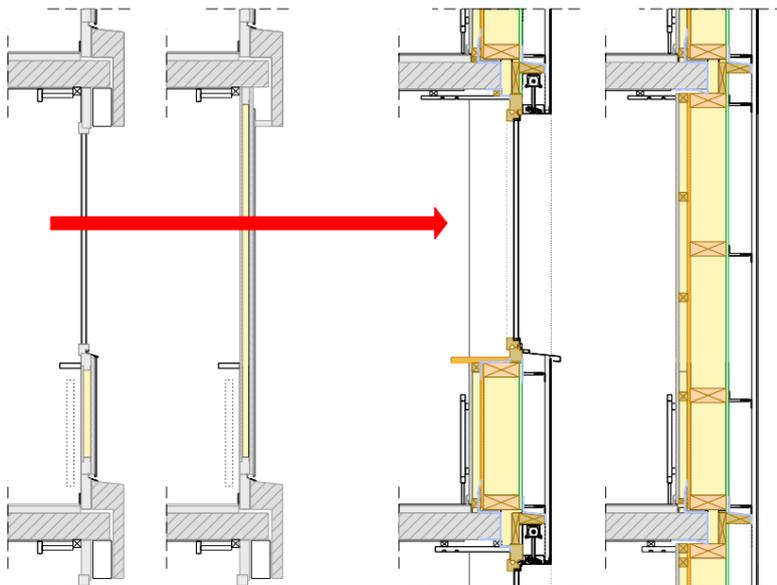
Rénovation d'un immeuble en centre-ville à Ebikon, architecte Lustenberger&Condrau – La mise en œuvre des modules d'ossature de 10 mètres de long par une hauteur d'étage a été réalisée en site occupé ; Le démontage et la mise en place du mur rideau préfabriqué ont pu être effectués en une seule journée pour couvrir la surface de façade de 3 logements soit environ 100 m² par jour.
